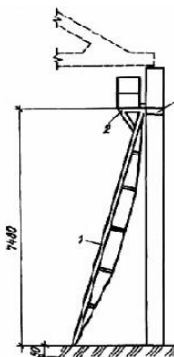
Монтажные лестницы с площадками с несущей конструкцией в виде шпренгеля; 1 - лестницы; 2 - площадка; 3 - элемент крепления к колонне
